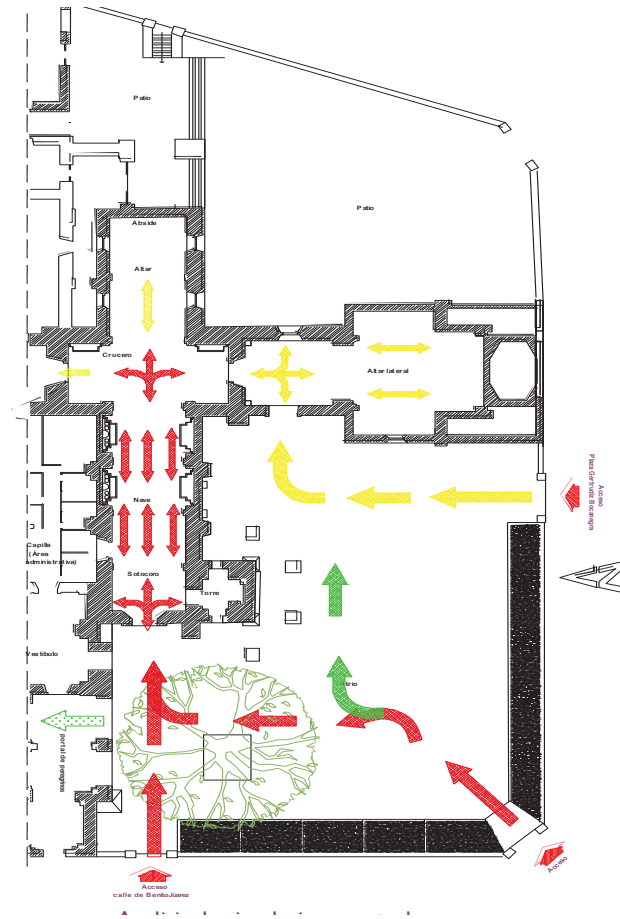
Planta baja, se indican tipo de circulaciones actuales,
